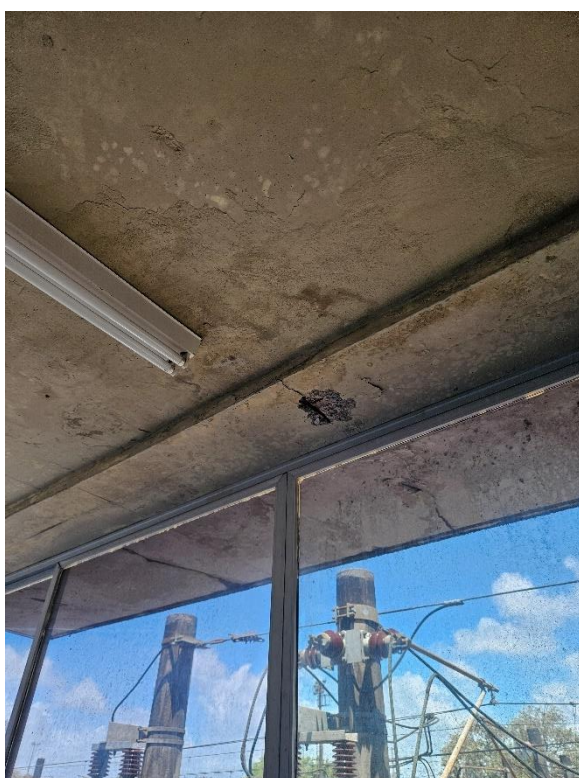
Sala dos Maquinistas – Infiltrações, Bicheiras e Ferragens Expostas
